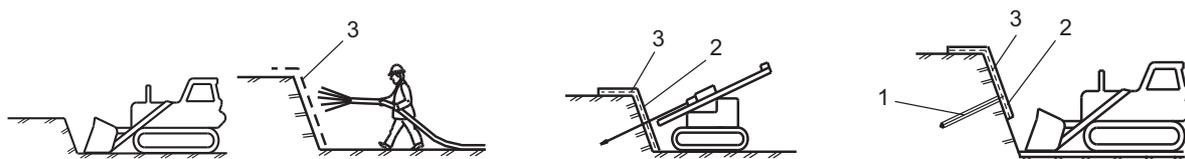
Технологическая последовательность нагельного способа горизонтального армирования стенки из торкрет-бетона: 1 – стержневая арматура; 2 – защитная стенка из торкрет-бетона; 3 – металлическая сетка
